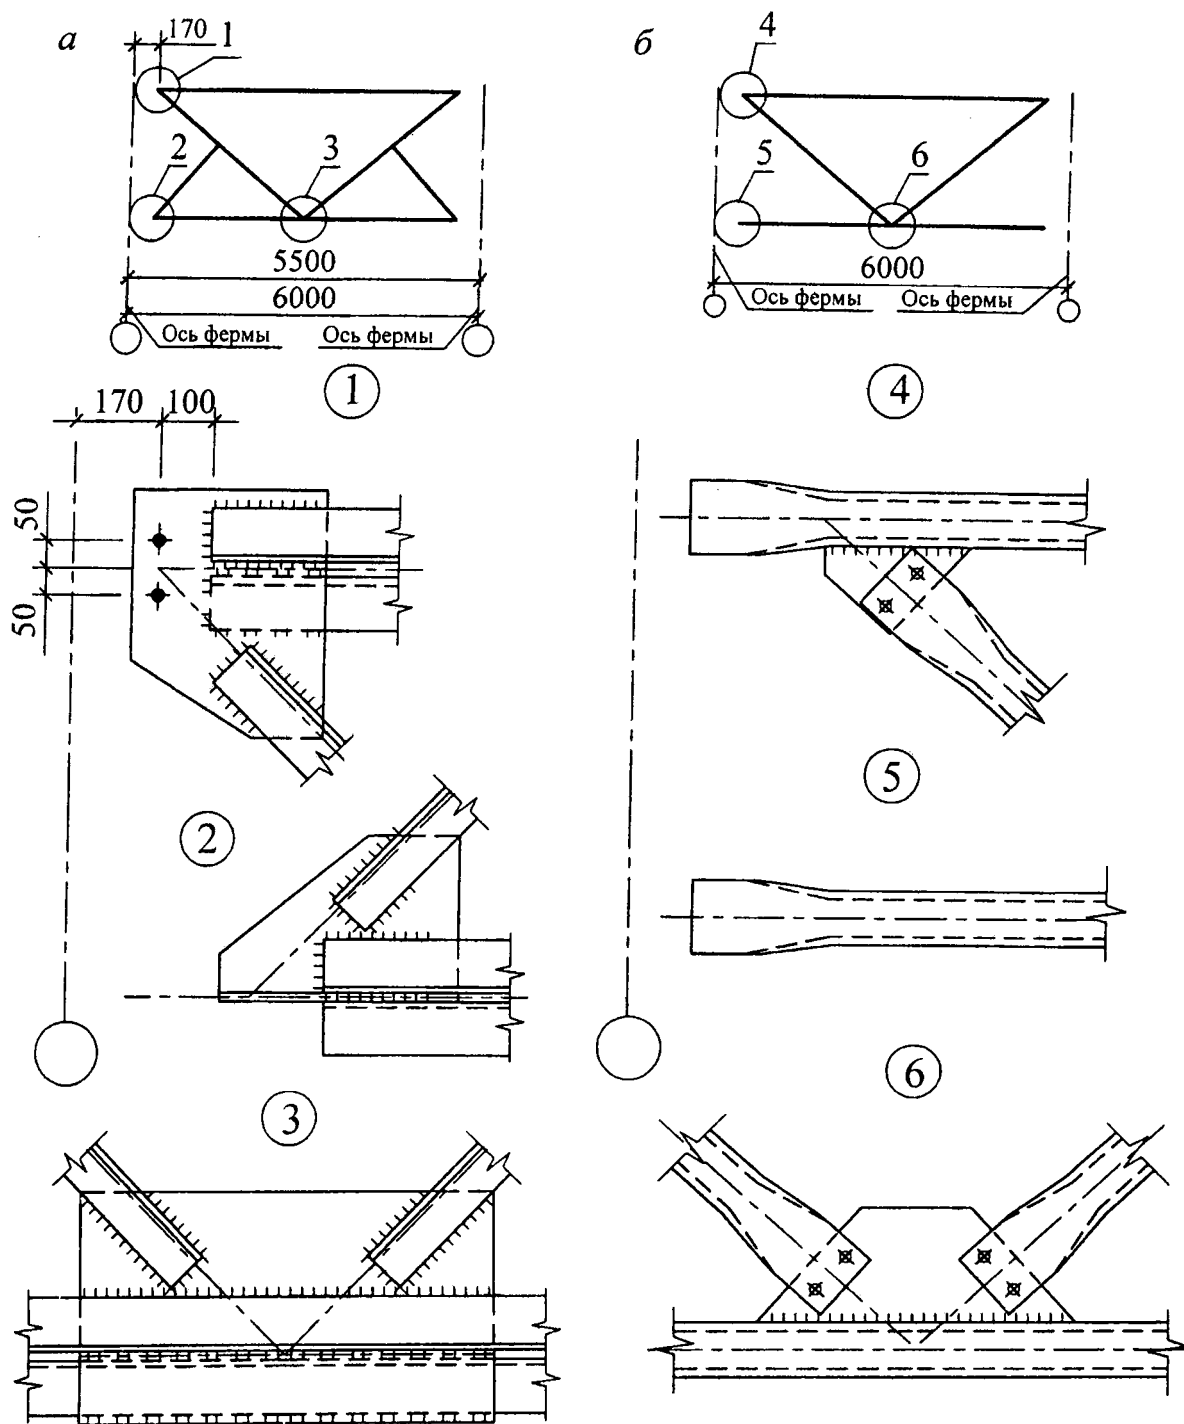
Конструктивное решение вертикальных связей из парных уголков (а) и из круглых труб (б) при шаге ферм 6 м
